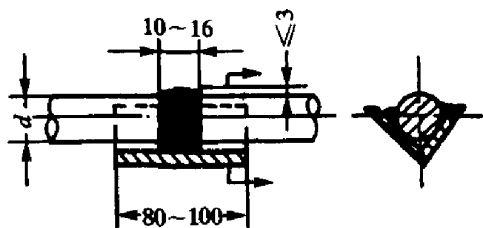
钢筋熔槽帮条焊接头
